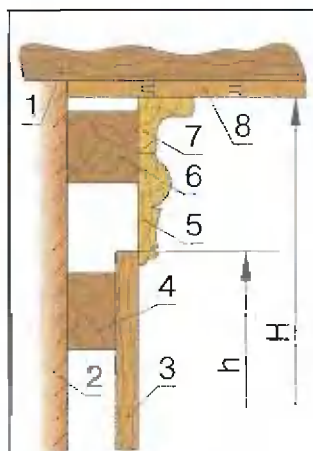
Отделка стыка стены с потолком:  $H$  — высота потолка;  $h$  — расстояние на стене, которое перекрывает вагонка; 1 — балка перекрытия; 2 — стена; 3 — обшивка стены; 4 — обрешетка; 5 — профильная планка (наличник); 6 — брусок подкладочный; 7 — плинтус; 8 — обшивка потолка
